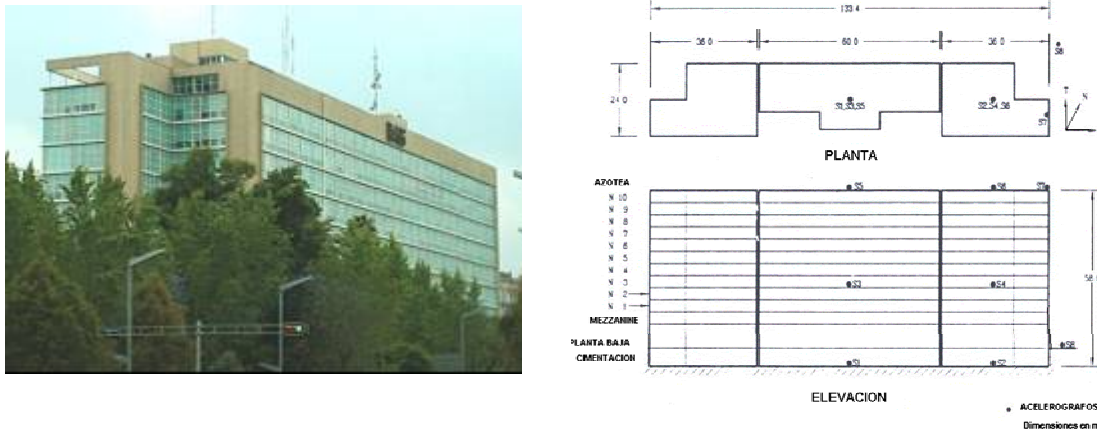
Vista esquemática (planta y elevación) del edificio instrumentado REF
